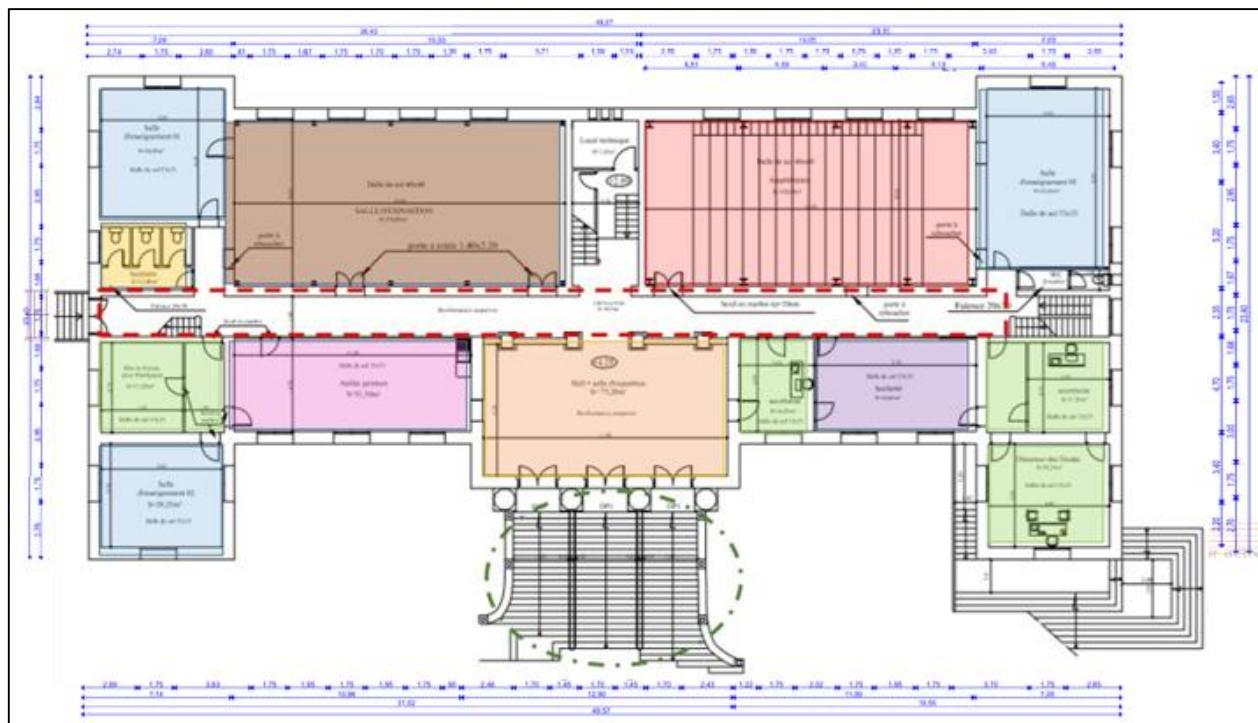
Plan de RDC avec cotations (Fond : plan de la direction de l'urbanisme. Traitement : auteur 2025.).
